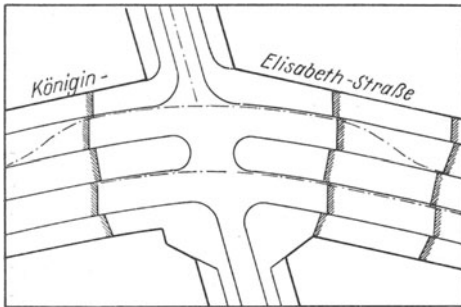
Stadtstraße mit einseitigem Quergefälle in der Krümmung.
